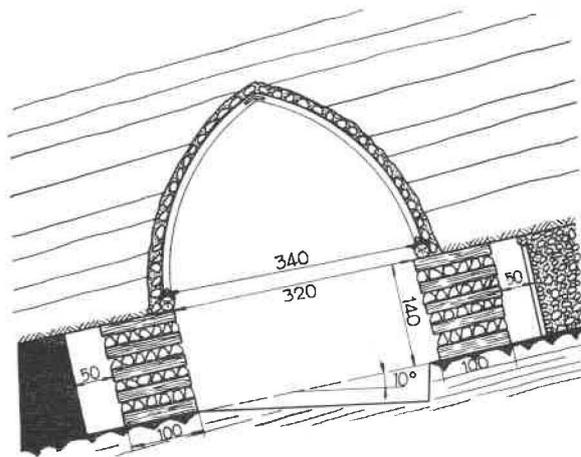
Application du soutènement articulé sur piles de bois en plateure.
